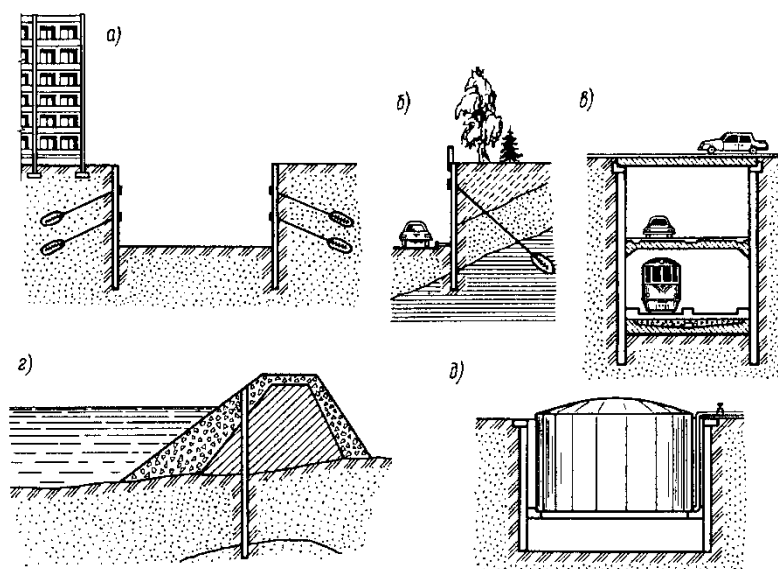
Конструкции, сооружаемые способом «стена в грунте»: а – котлованы в городских условиях; б – подпорные стенки; в – тоннели; г – противодиффузионные диафрагмы; д – подземные резервуары
